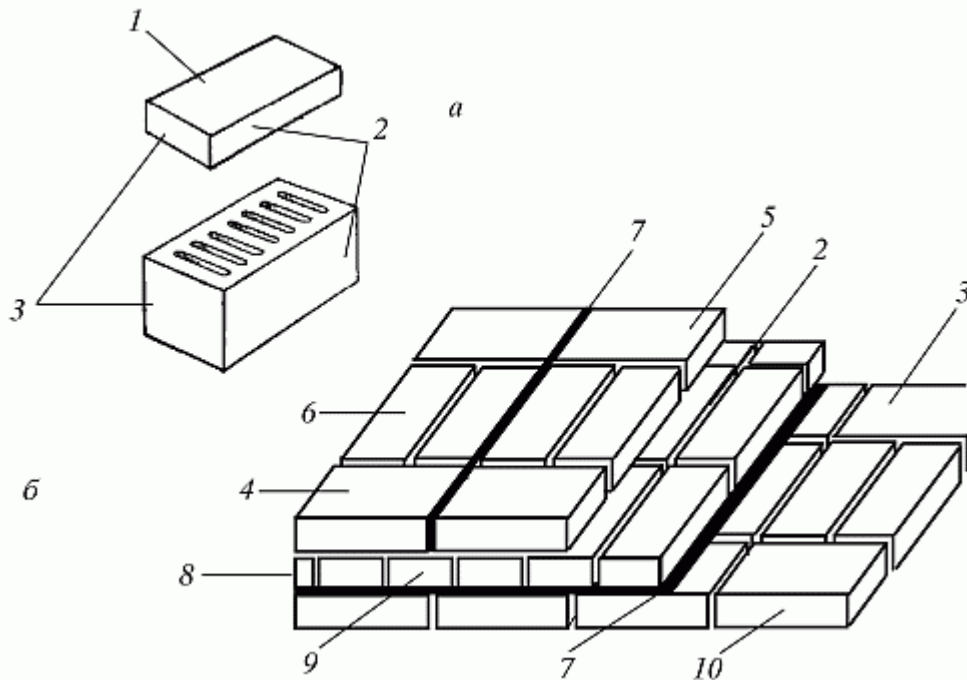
Стороны кирпича и камня (а) и элементы каменной кладки (б): 1 – постель; 2 – ложок; 3 – тычок; 4 – наружная верста; 5 – внутренняя верста; 6 – забутка; 7 – горизонтальный и вертикальный швы; 8 – фасад; 9 – тычковый ряд; 10 – ложковый ряд
